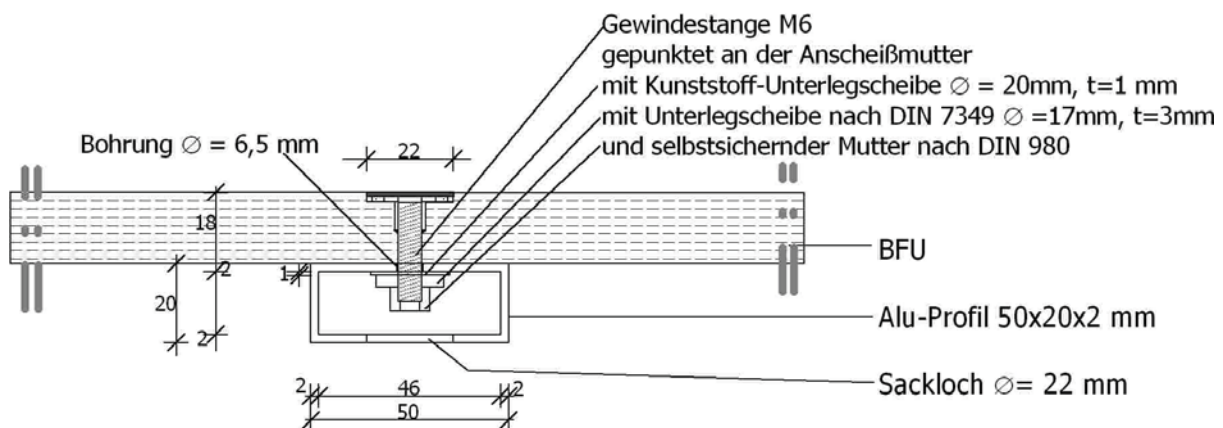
Horizontalschnitt durch die BFU-Platte und ein vertikales Alu-Profil (50x20x2 mm) der Unterkonstruktion
